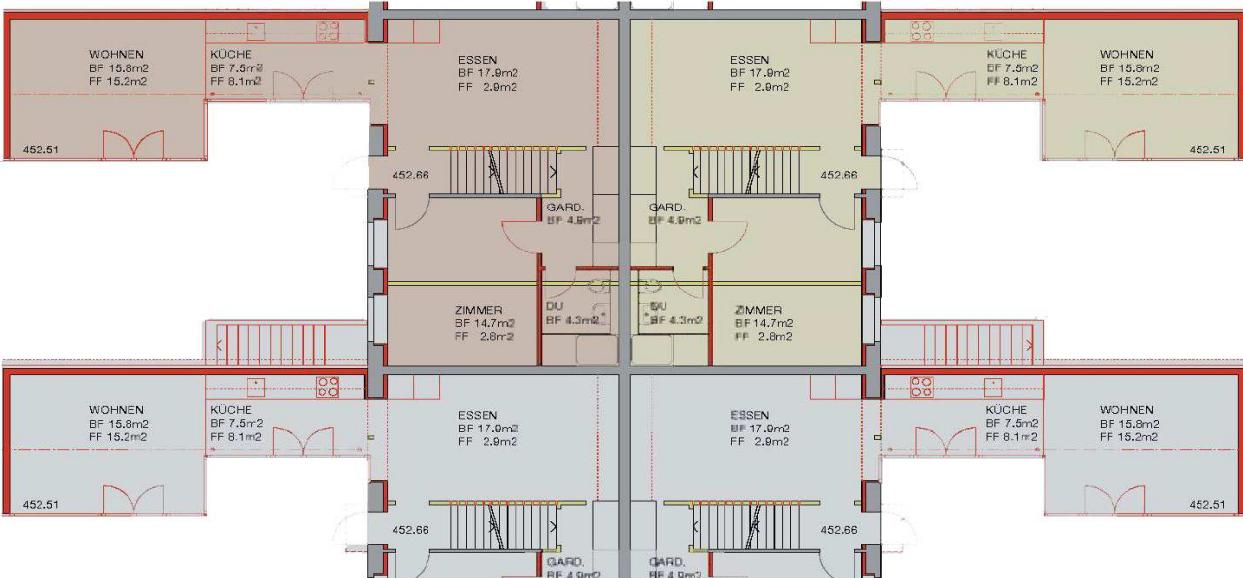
Grundriss, Birchermusli - Quartier.
